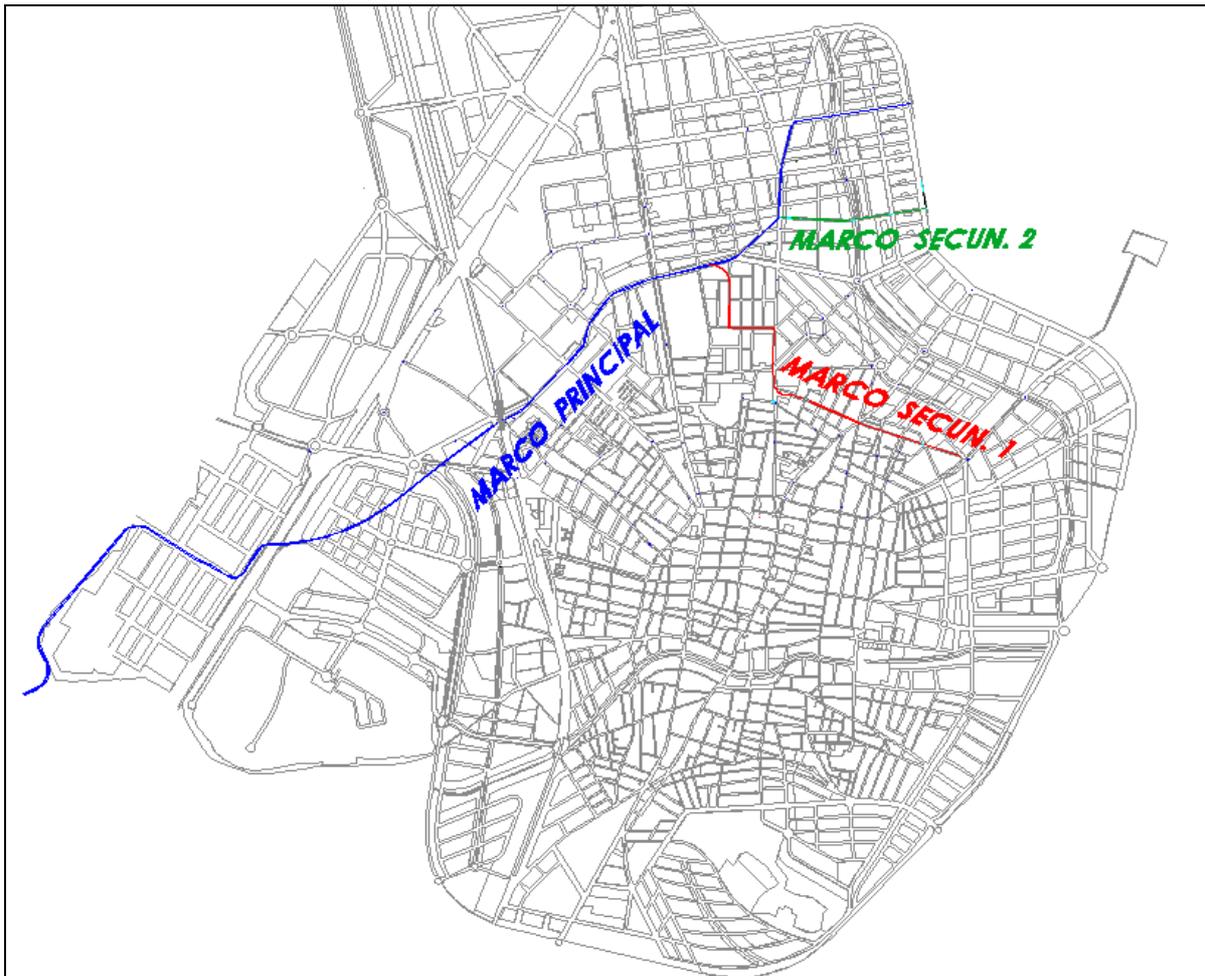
Trazado en planta de la red de drenaje urbana (Sin Escala)
